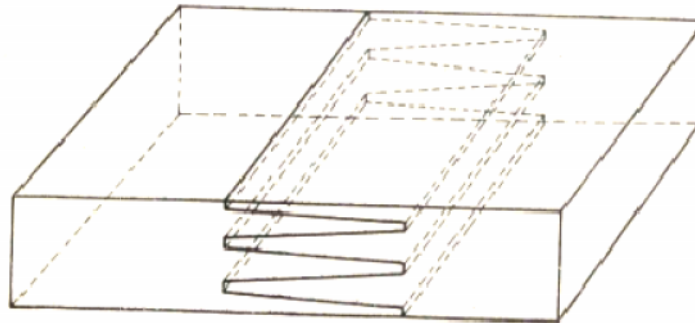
Ensamblaje en seco viga 10 de teca en MLPE
